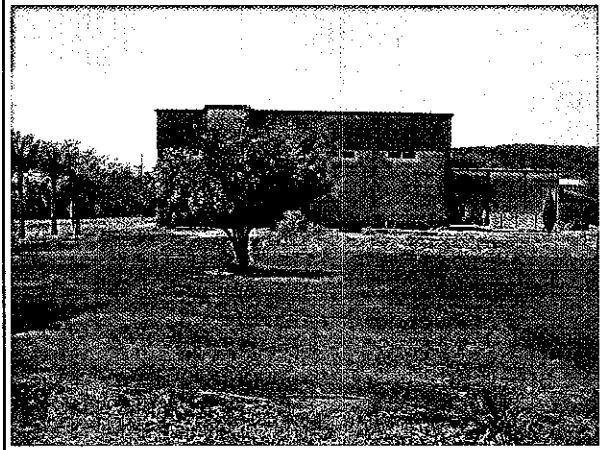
a área esta limpa e somente as estruturas de interesse do proprietário foram mantidas. O proprietário esta construindo uma instalação no local.
